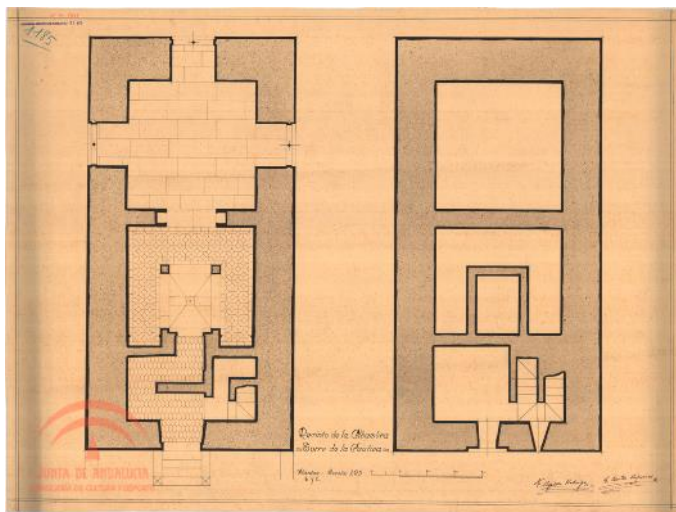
Torre de la Cautiva: Plantas baja y segunda
